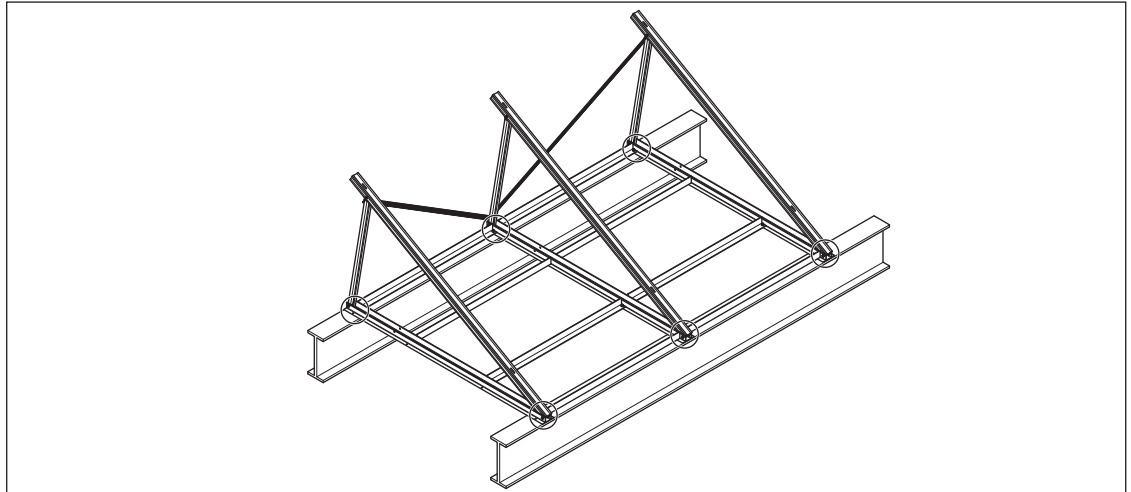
Freistehende Falchdachkonstruktion durch Unterkonstruktion sichern
